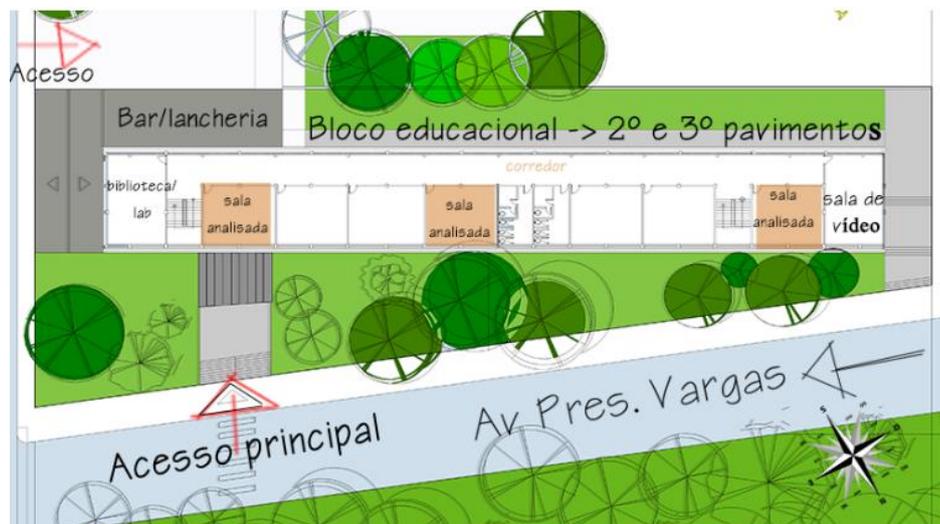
configuração espacial repetida 2 e 3 pavimento (salas analisadas em laranja)
